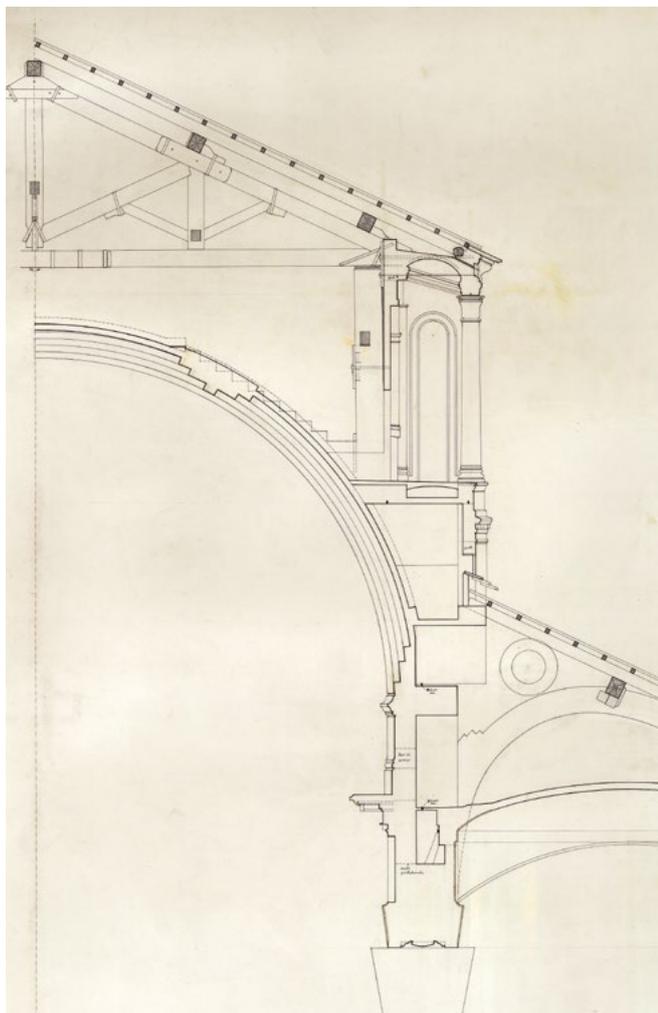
Sezione verticale (scala 1:20) di parte della navata del Duomo antonelliano di Novara (rilievo del 1988): la sottile volta a botte nervata con le sovrastrutture murarie, la galleria esterna e la carpenteria di copertura. © Fondo Franco Rosso, Archivio di Stato di Torino.
